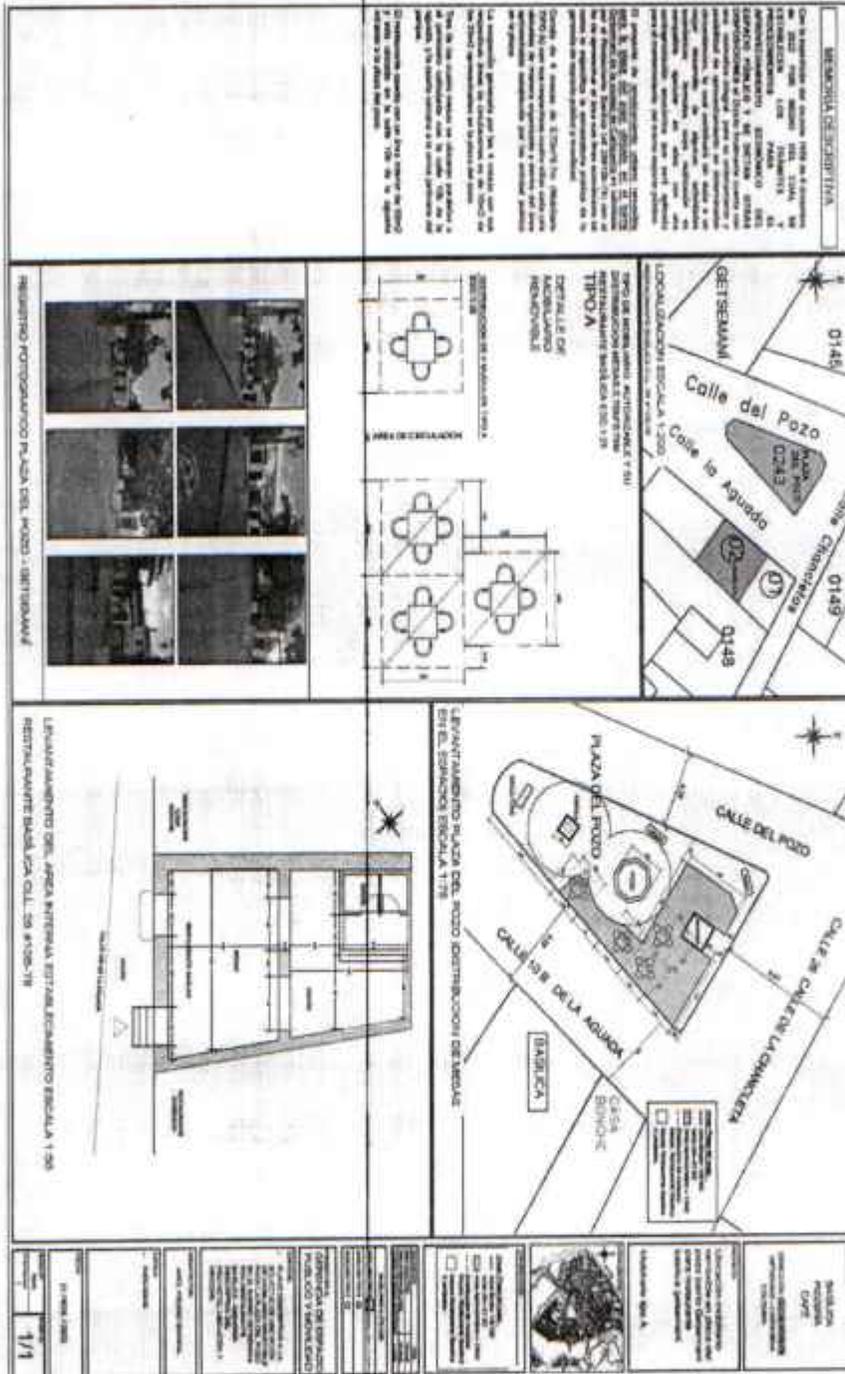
Plano RESTAURANTE BASÍLICA PIZZERÍA CAFÉ.
